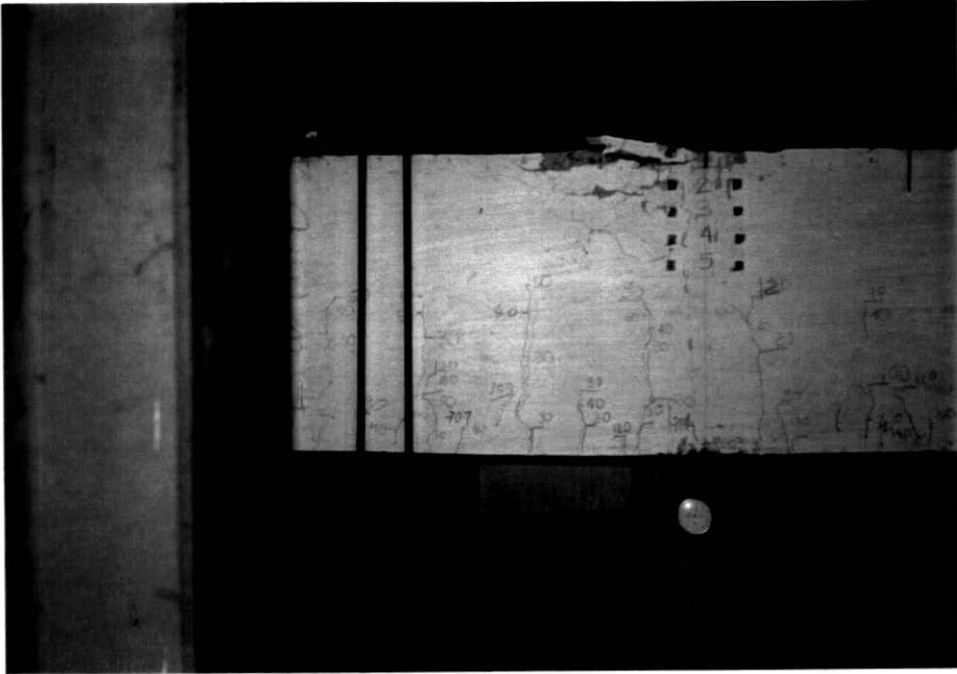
Ruptura da viga V2 - esmagamento do concreto após o escoamento da armadura longitudinal
